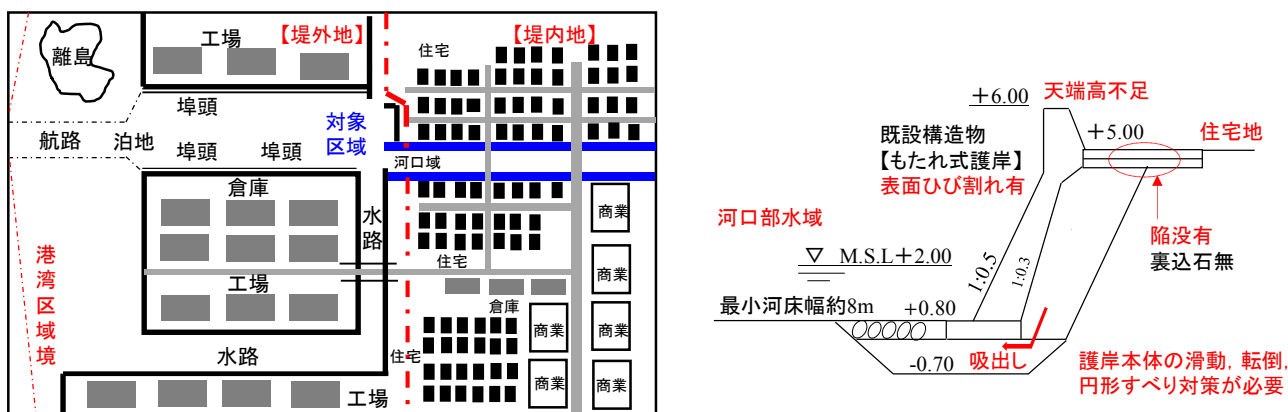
(1) 改良・補修対象とした防潮護岸の平面位置図と断面図
